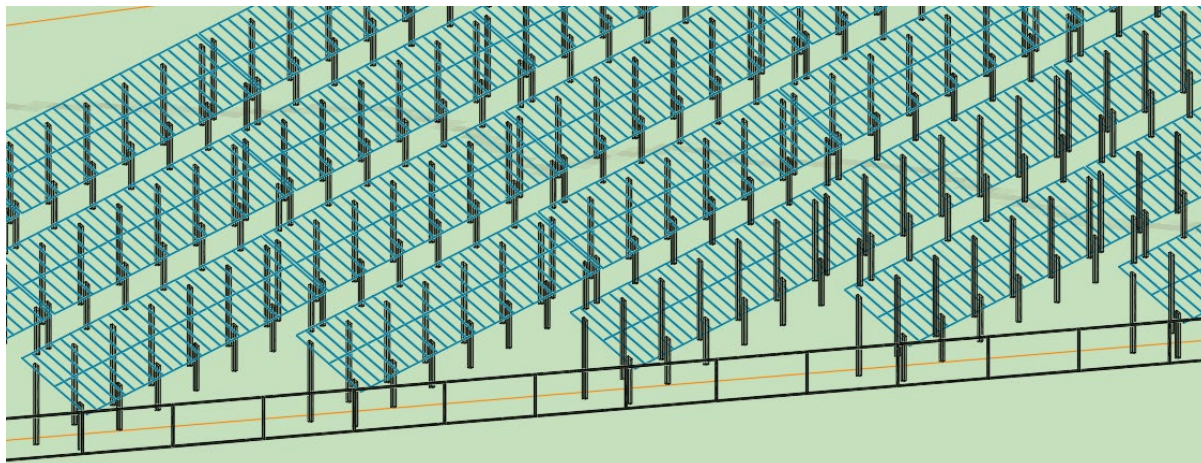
Oversiktsbilde av gruppe 1 (til venstre), gruppe 2 (øverst til høyre) og gruppe 3 (nærmest til høyre).
